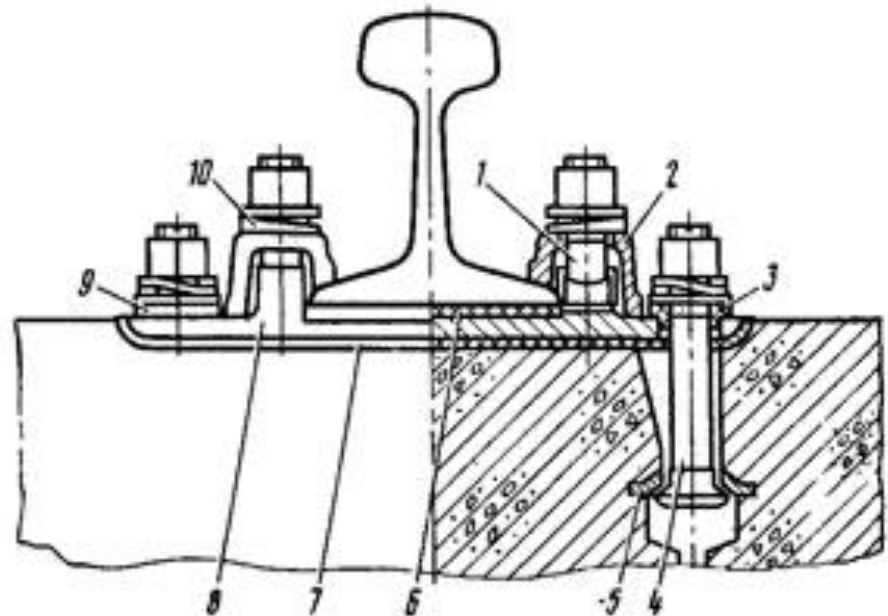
Раздельное крепление типа КБ для железобетонных шпал
